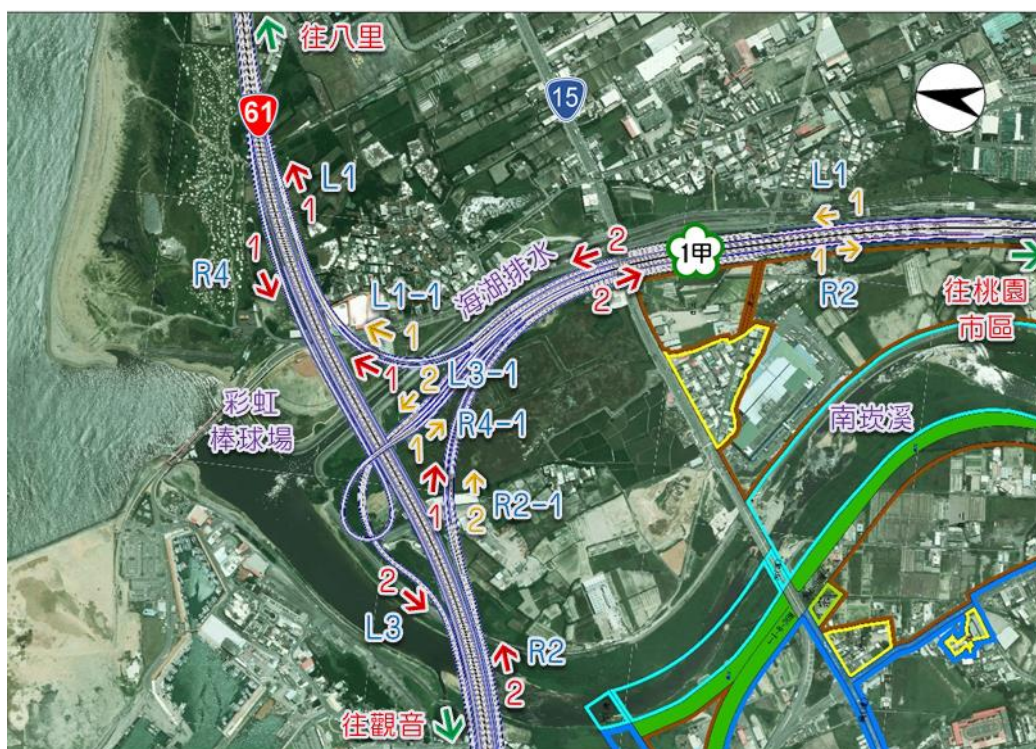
台 61 系統交流道方案二平面示意圖
